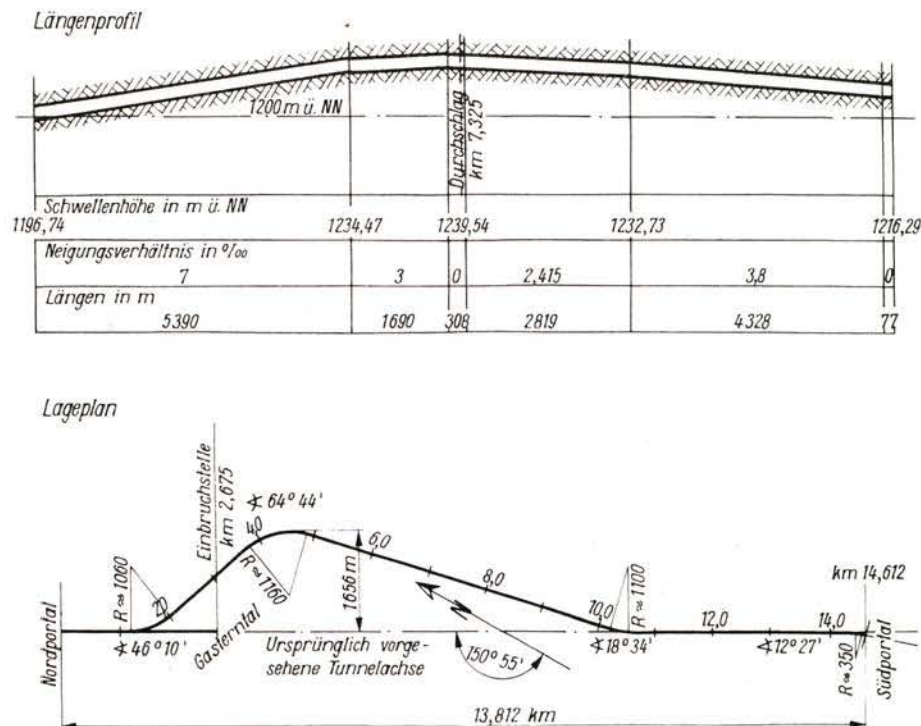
Längenprofil und Lageplan des Lötschbergtunnels[1]
